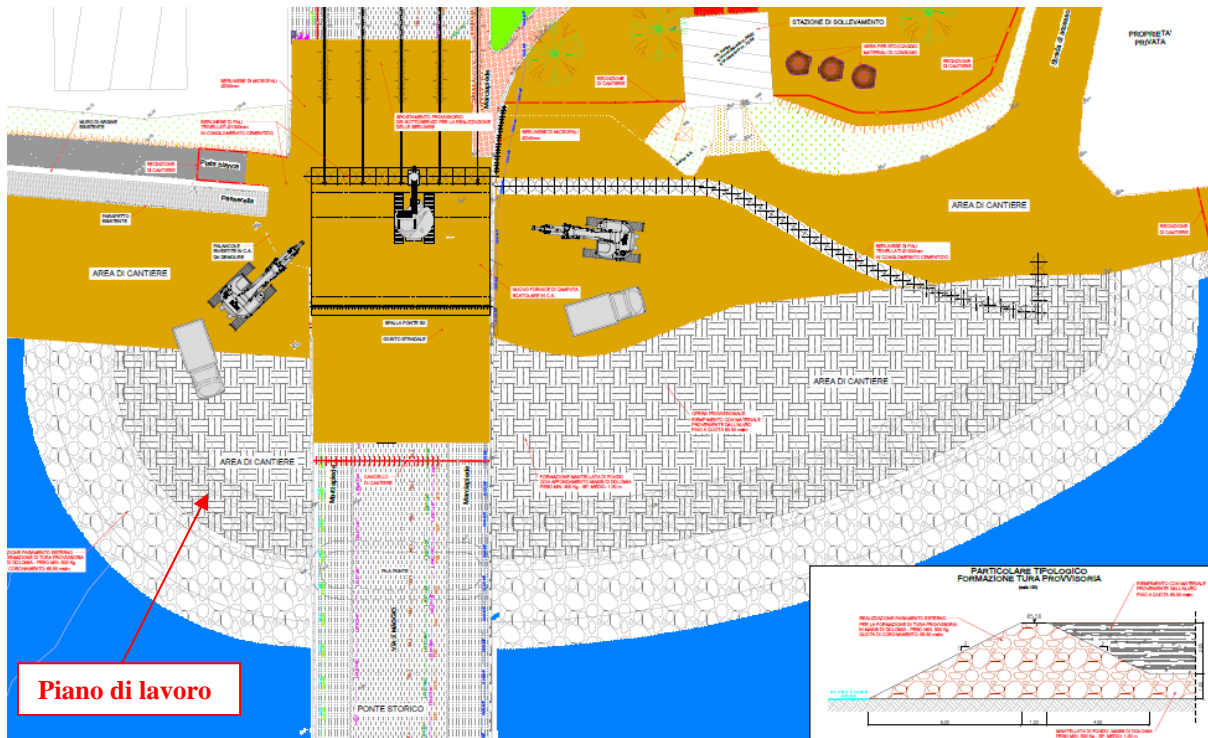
Stralcio Tav. D.06.01 – Planimetria di cantiere
